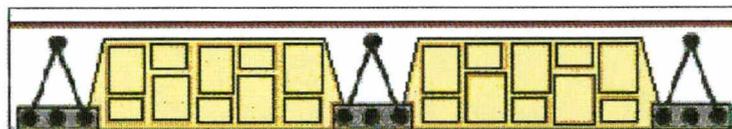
Corte das vigotas treliçadas e os blocos.
